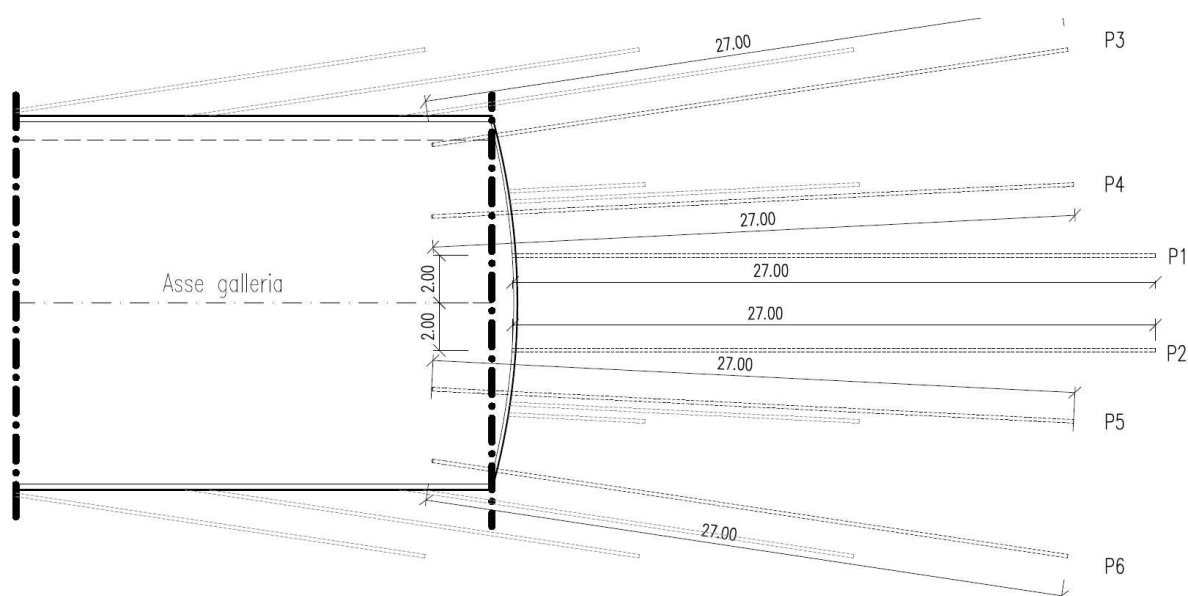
Perforazioni in avanzamento. Schema posizionamento fori – planimetria
